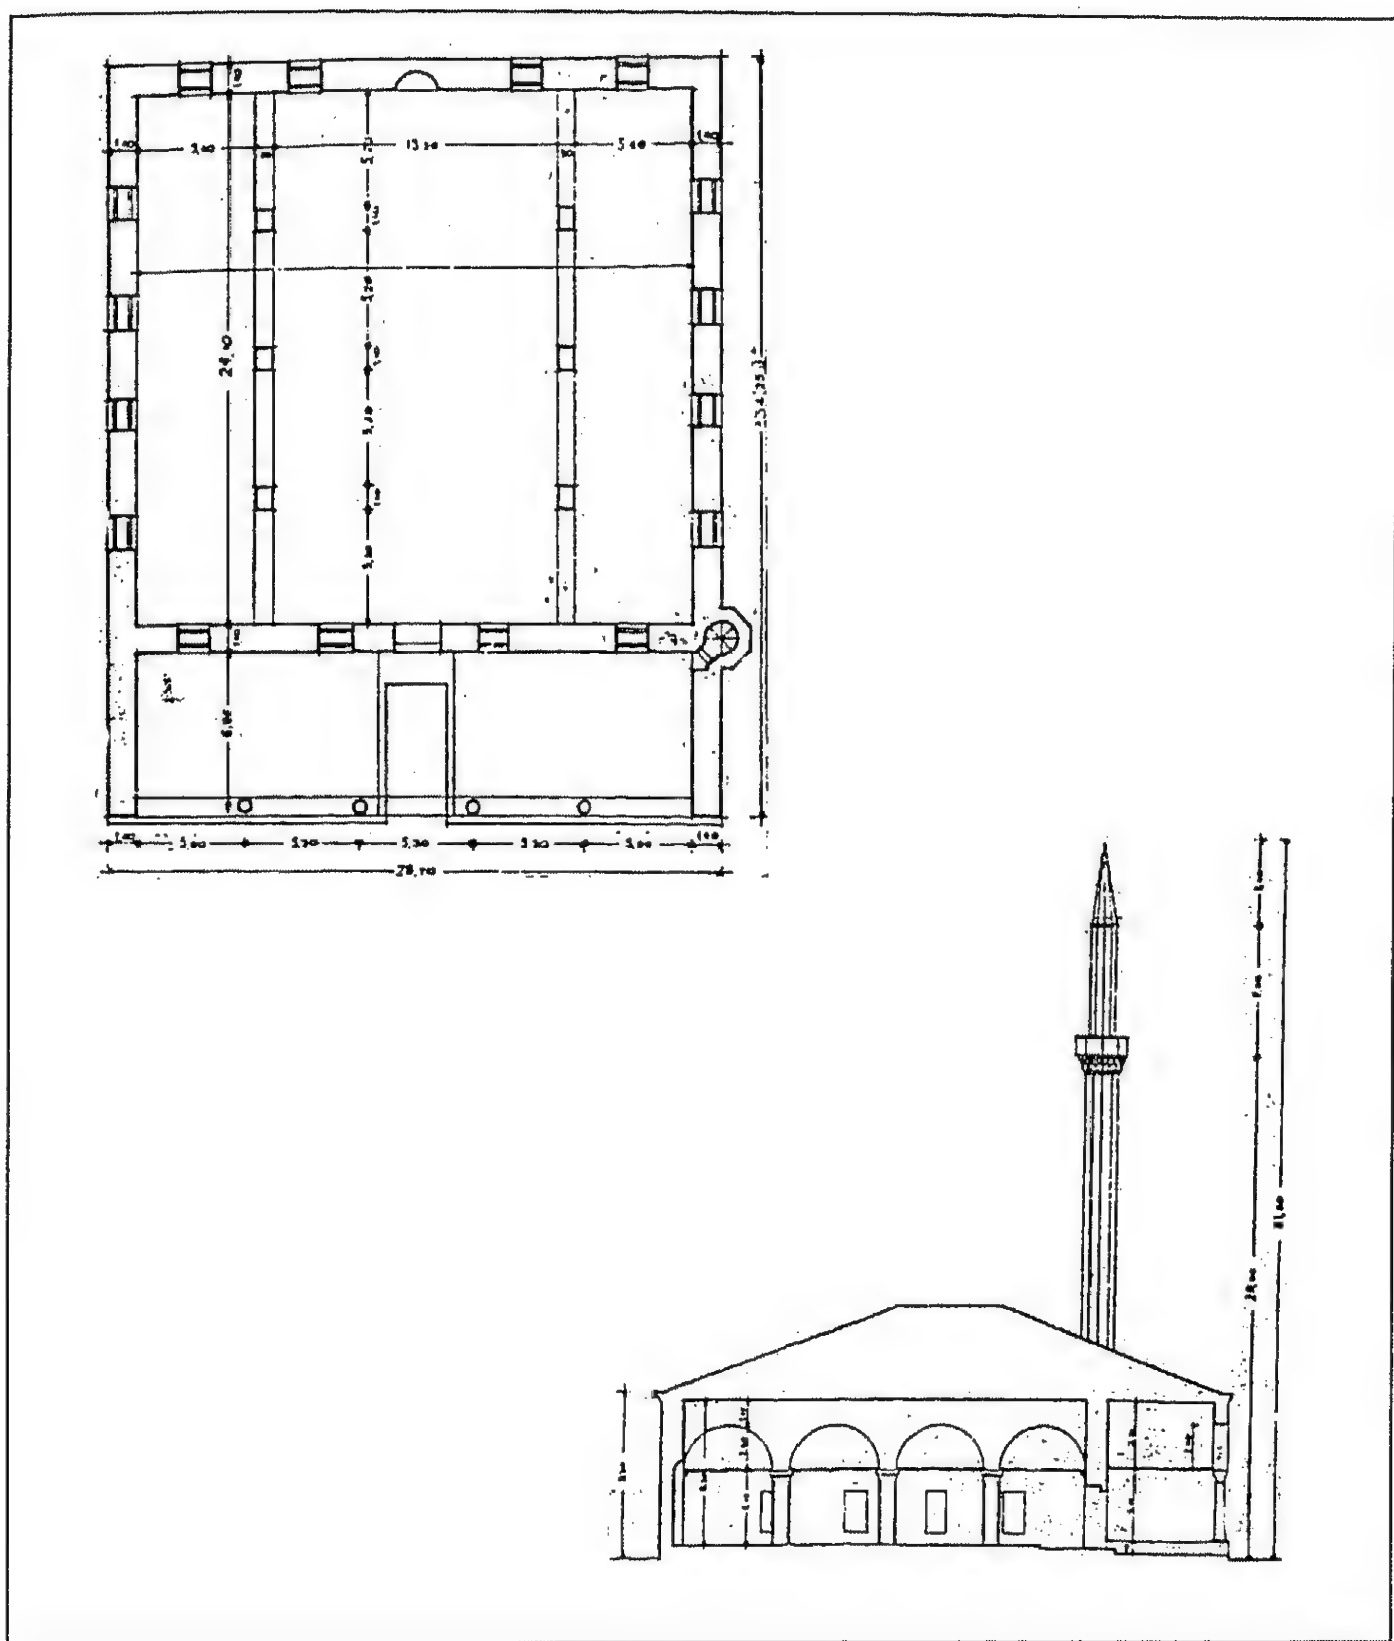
مسقط أفقي لمسجد ذنجري في سيريز باليونان (عن : كيل)
